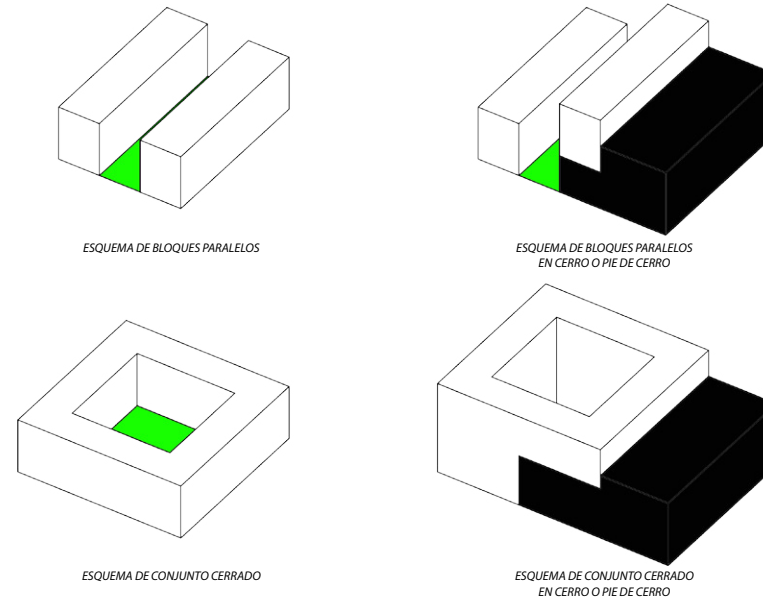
| Esquema de conjunto vivienda colectiva | Elaboración propia
